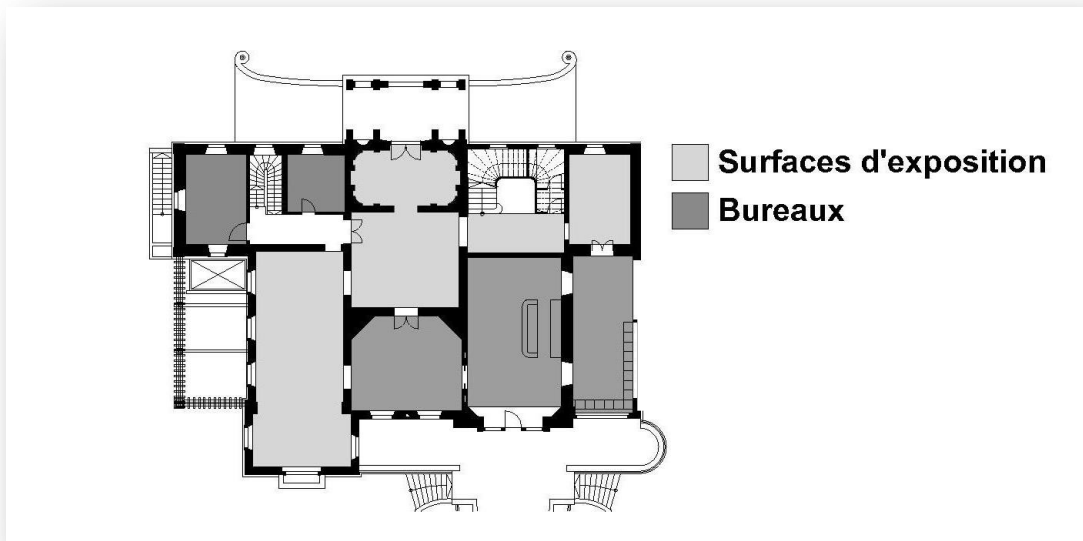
Villa de Pury, rez-de-chaussée: occupation des espaces, *état existant
